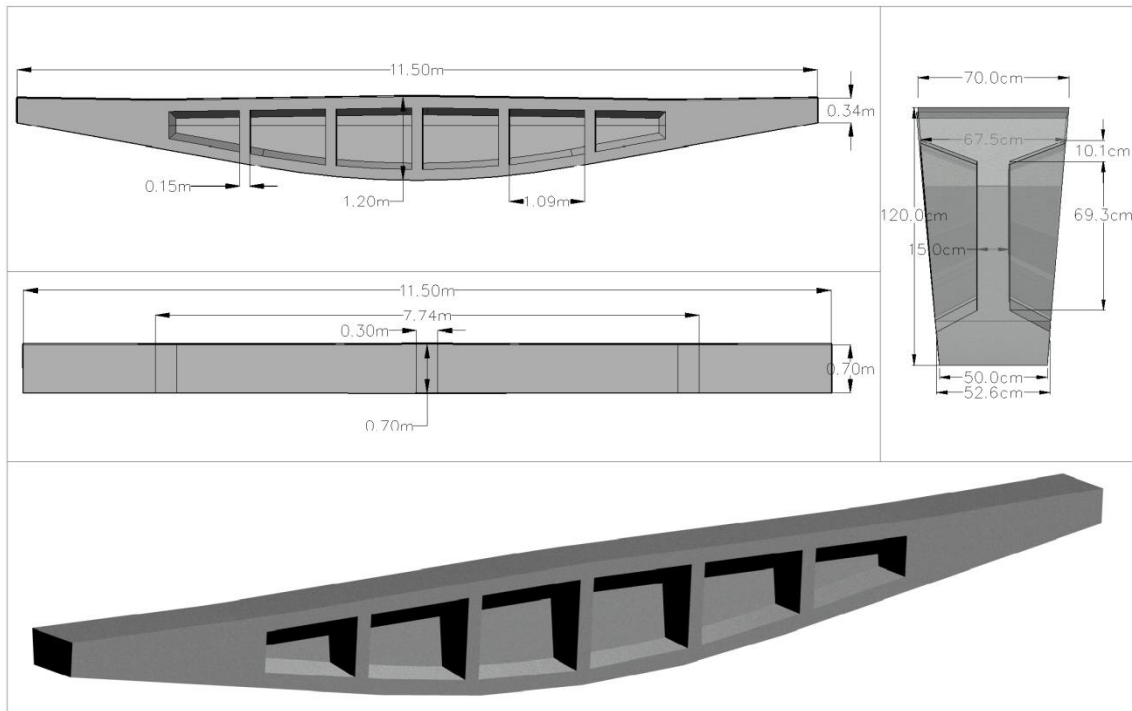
Carlinga, alçado, planta, corte e perspectiva.
